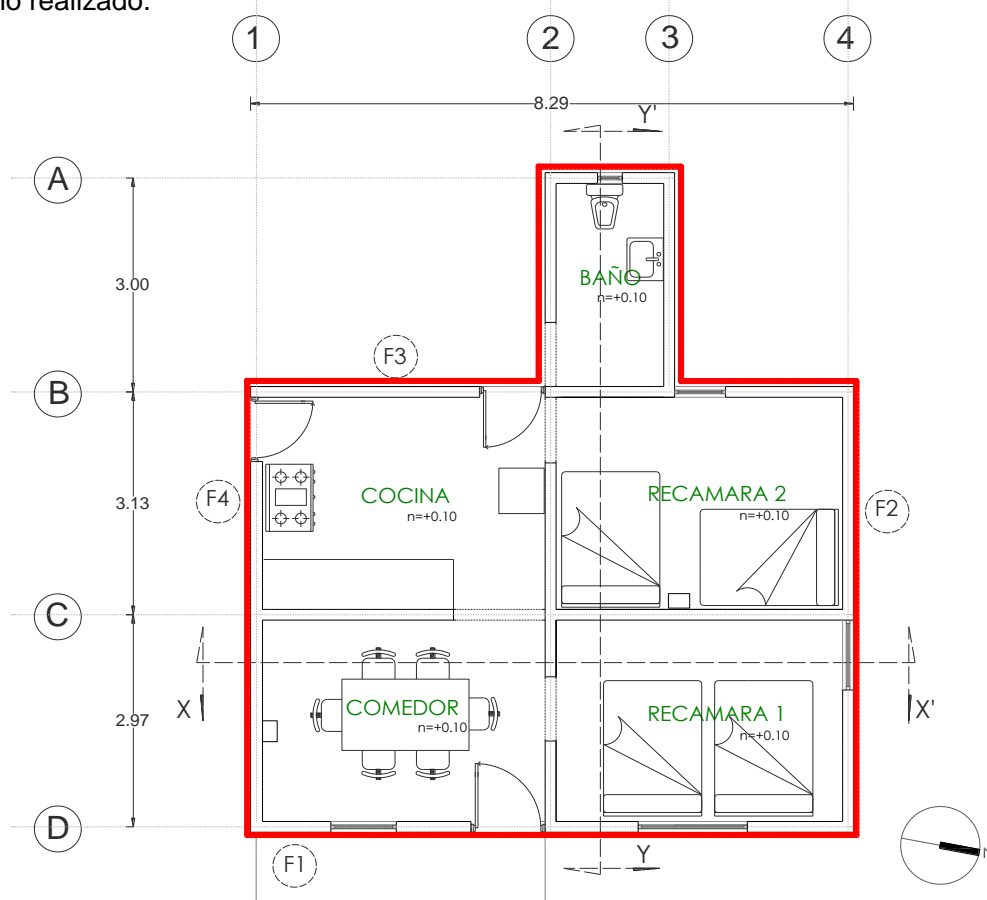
Planta arquitectónica de la vivienda analizada. Fuente: Elaboración propia.
